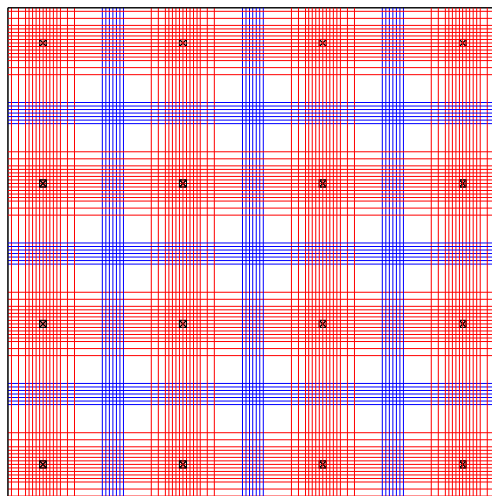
Alternativa de traçado 1 dos cabos no pavimento com balanço
